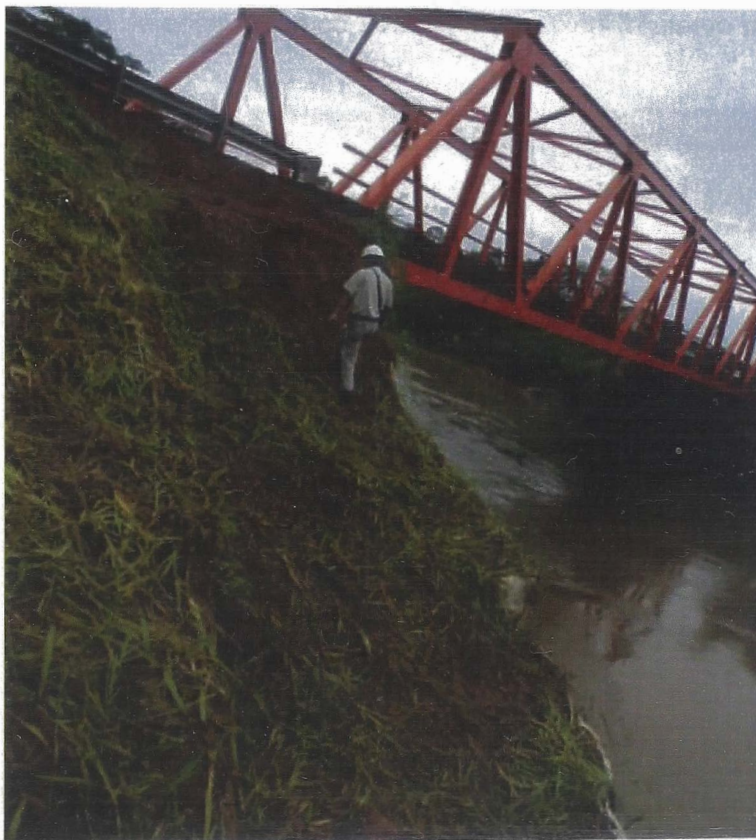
Terraplén sobre las geobolsas del estribo izquierdo de puente Mavila. Se muestra afectado por el proceso de socavación.
